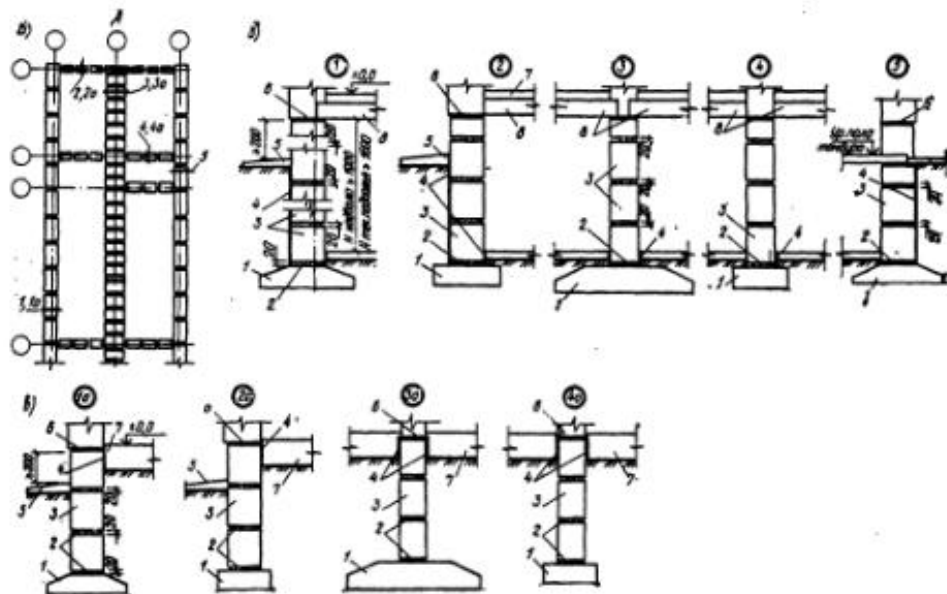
Сборные ленточные фундаменты из бетонных блоков: а - монтажная схема с маркировкой сечений; б - детали сечений фундаментов под стены зданий с подвалами и техническими подпольями; в - детали сечений фундаментов под стены зданий без подвалов и технических подполий; 1 - фундаментная плита; 2 - цементно-песчаный раствор; 3 - бетонные стеновые блоки; 4 - окраска горячим битумом за два раза; 5 - отмостка; 6 - два слоя толя или гидроизоляция на битумной мастике; 7 - конструкция пола; 8 - цокольное перекрытие
